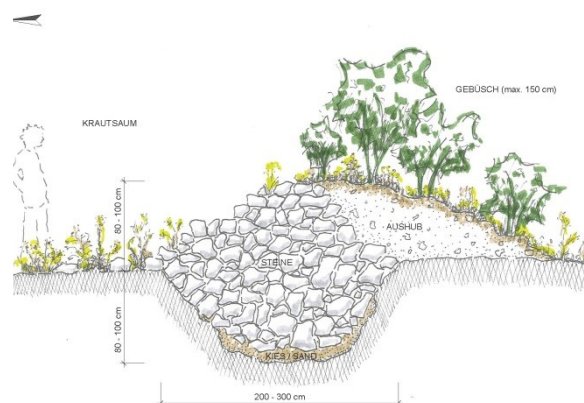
Coupe transversale d'un murgier (source : Barbara Kirsch / Karch)
